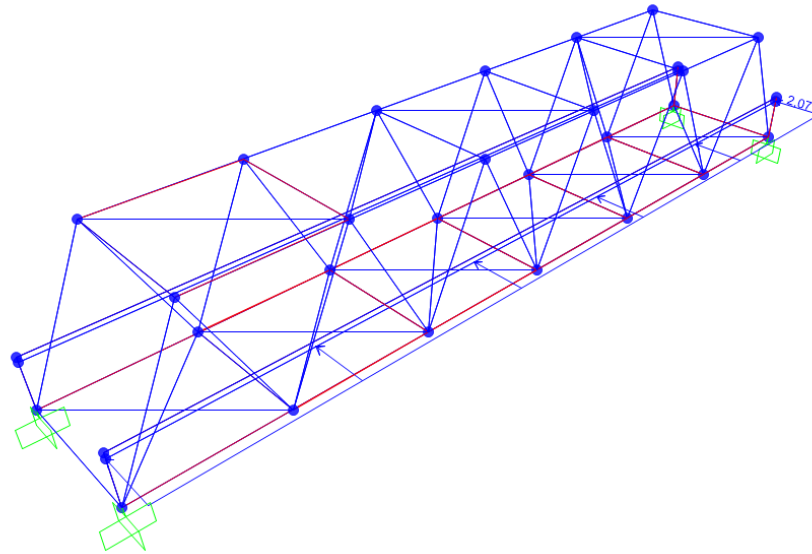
Aplicación de cargas de viento empuje horizontal positivo.
